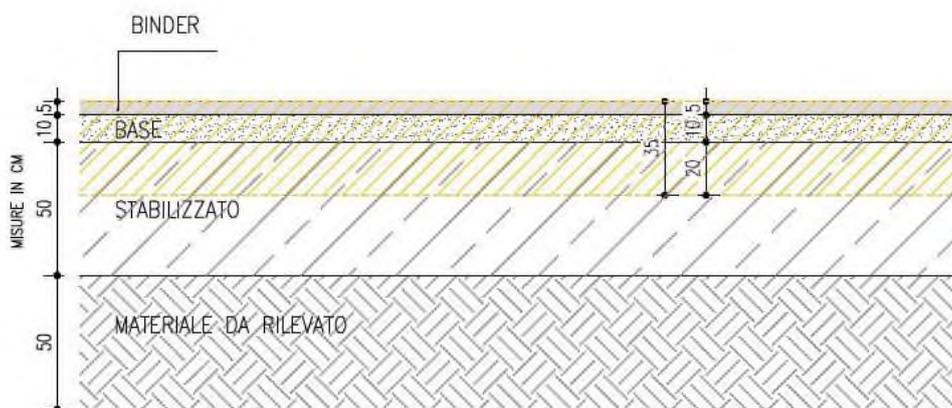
Esempio di pavimentazione di cantiere di cui demolire lo strato superficiale del manto.
